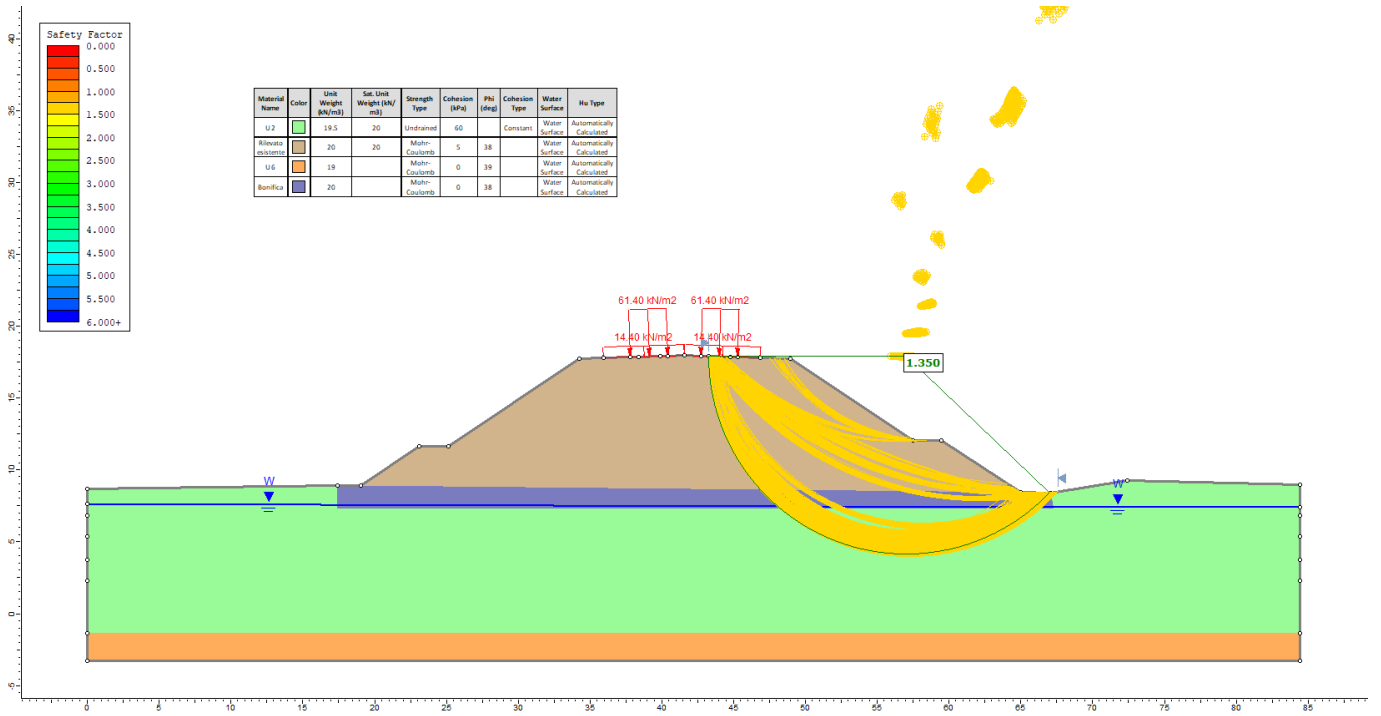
Rilevato sezione n° 16 pk 183+126 - Analisi SLU in campo statico DA1C2
